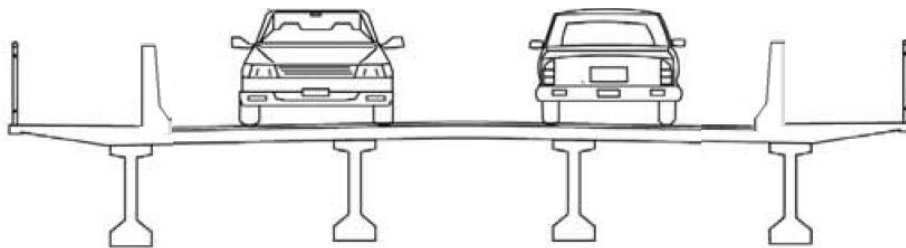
Sección de Puente Tipo en Zona Urbana. Fuente: [2].
